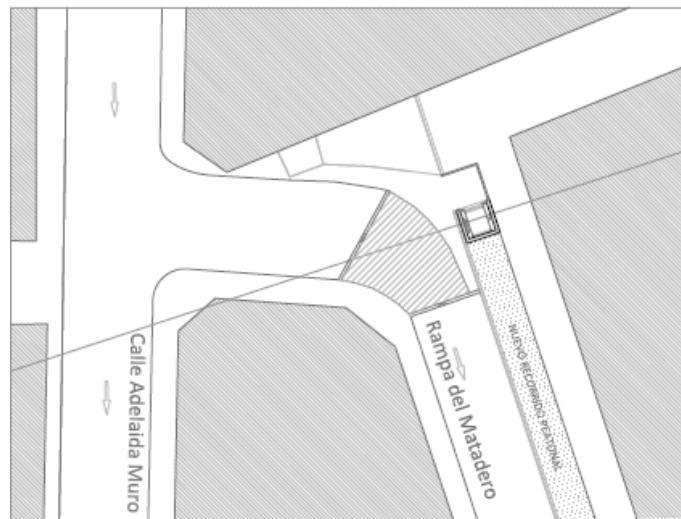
Fig X. Plano esquemático de la ubicación de la propuesta del ascensor en la Rampa del Matadero.
